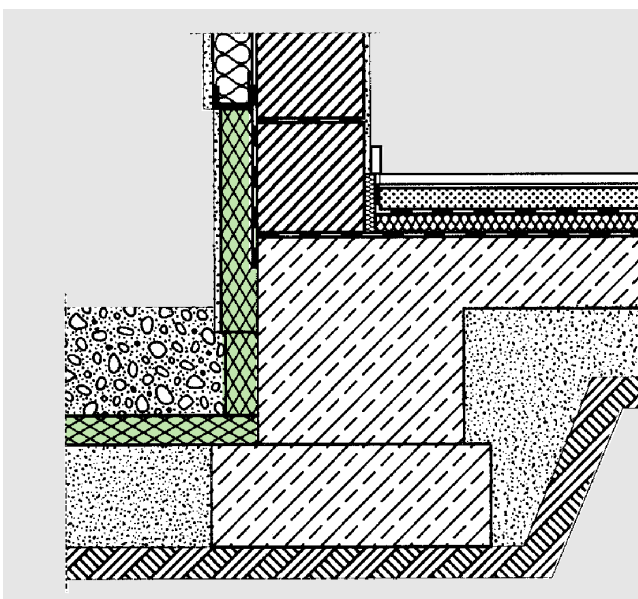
Возможности теплоизоляции фундамента от промерзания. При выборе размеров и исполнения теплоизоляции для защиты фундамента здания от промерзания следует руководствоваться стандартом DIN EN ISO 13793 «Теплозащита, фундаменты зданий, защита от промерзания».
